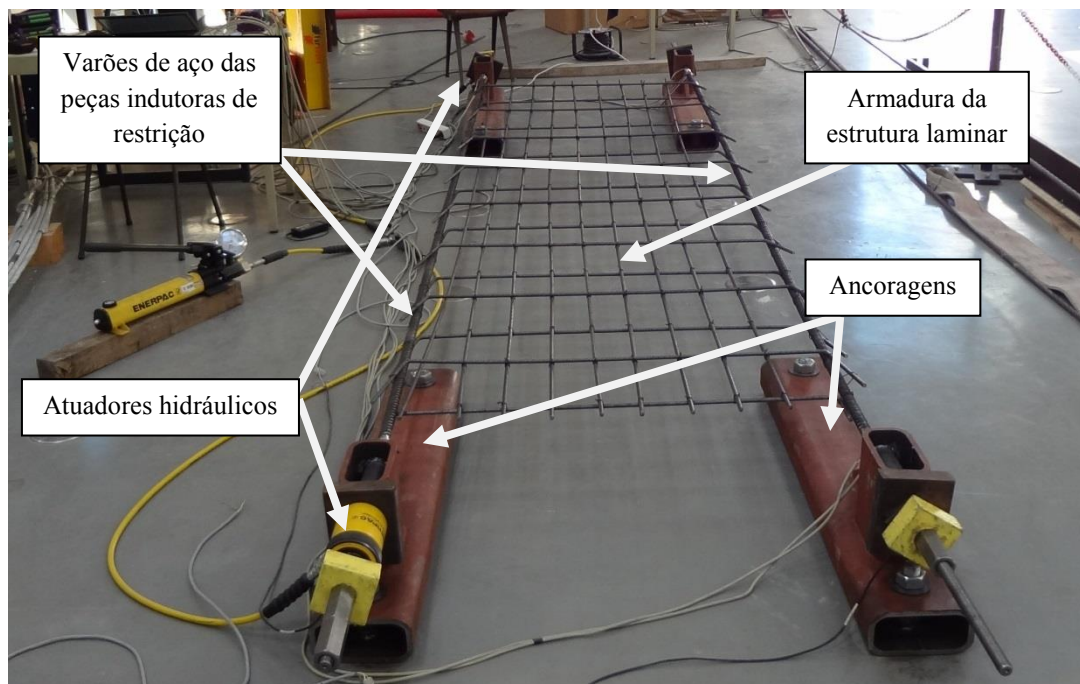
Vista geral antes da betonagem e armadura da estrutura laminar.
